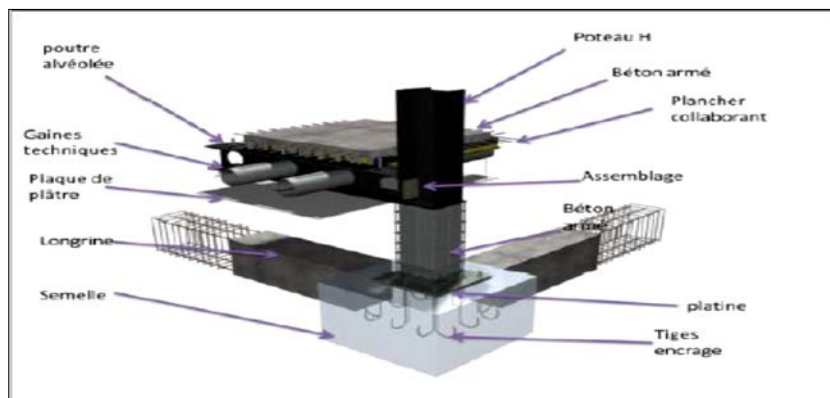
Détail d'assemblage poteau-poutre-plancher
